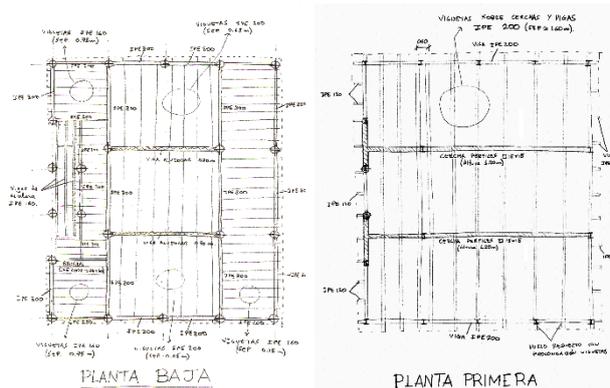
Croquis de análisis de estructura horizontal de los forjados de Planta Baja y Planta Primera. En ellos se observa las direcciones de carga de los mismos, así como los elementos que los componen. Elaboración propia.
